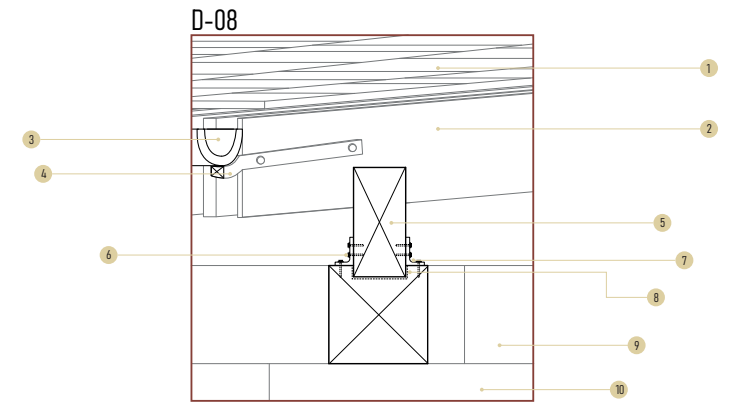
CORTE POR FACHADA 04 Y DETALLES ESTRUCTURALES 08-09.
